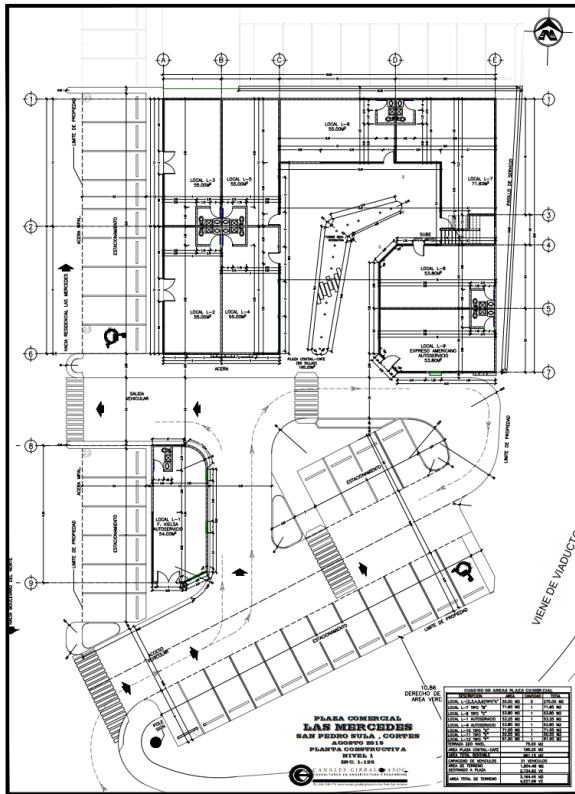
Planta constructiva Plaza Las Mercedes nivel1
